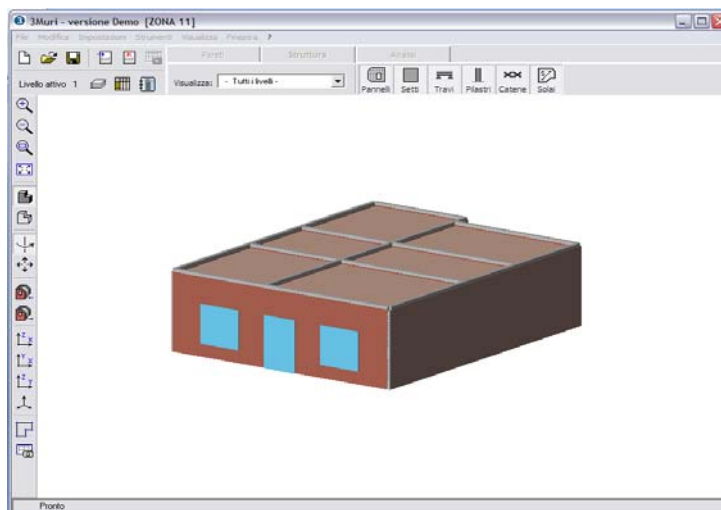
Vista 3D con placa de la casa zona 11, 3Muri
